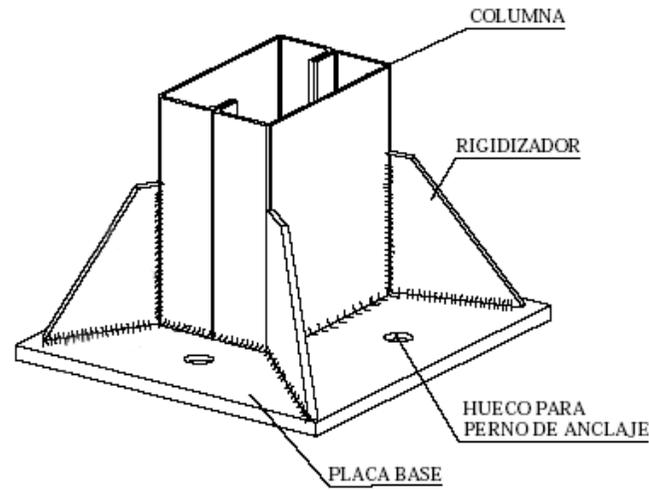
Ejemplo de columna de acero estructural, placa base.
